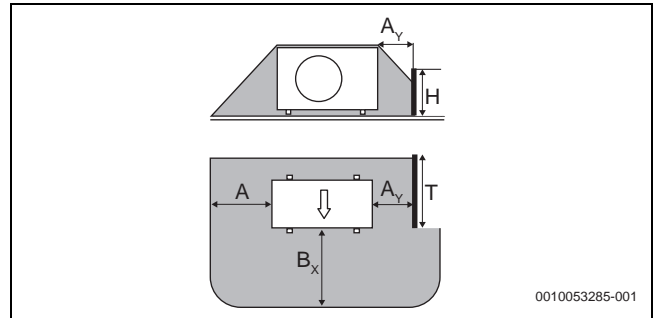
Schutzbereich mit Barriere rechts, bodenstehende Wärmepumpe
